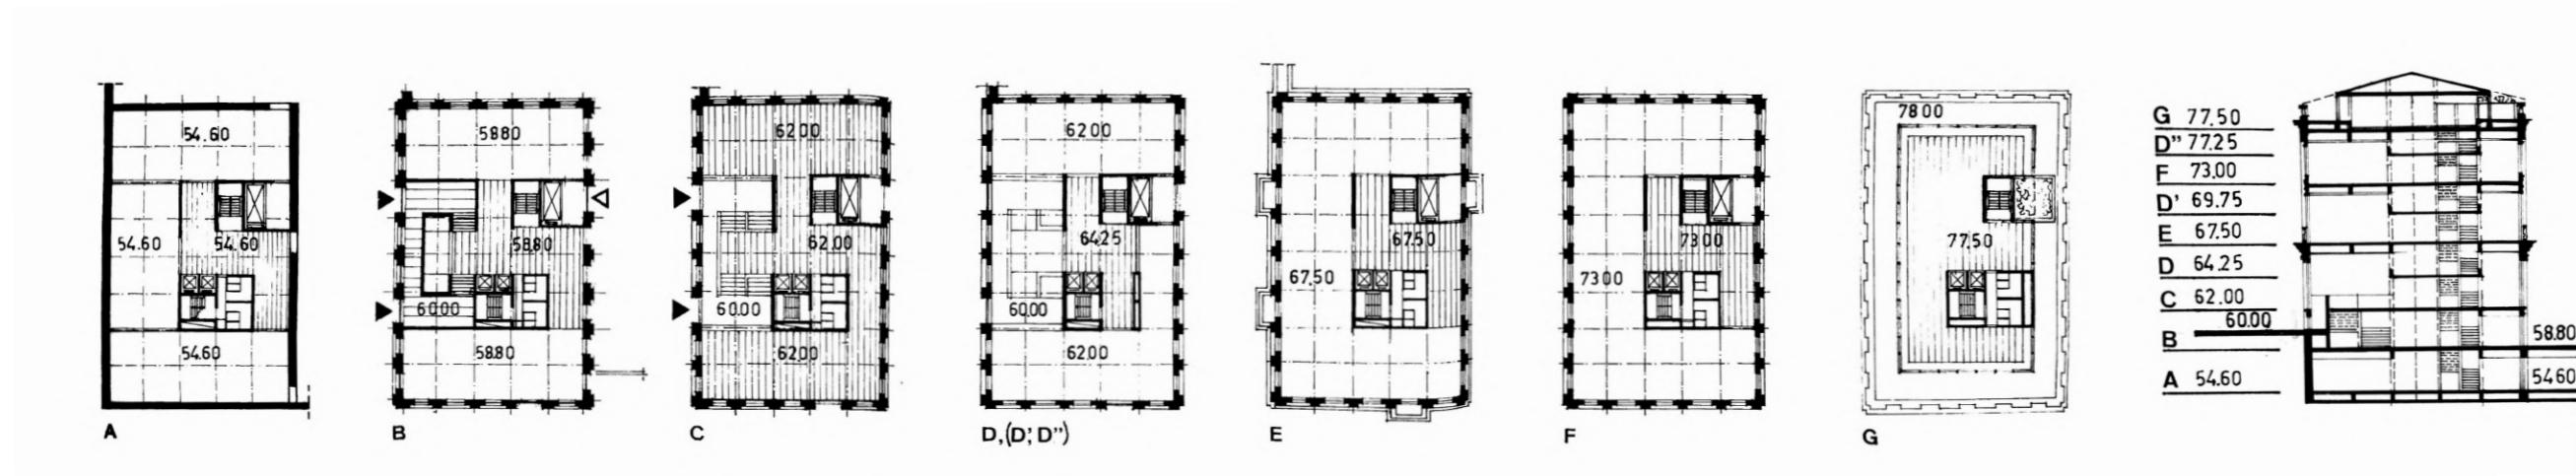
Plans et coupe de l'Altenloh, avant-projet du musée signal.
